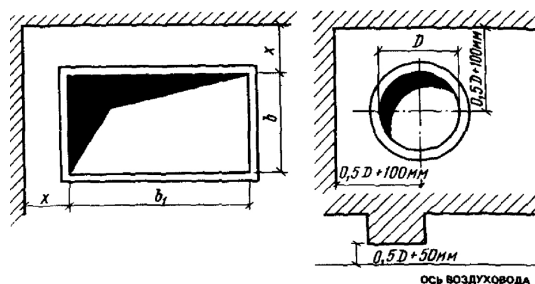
Минимальные монтажные расстояния от строительных конструкций до воздуховодов
